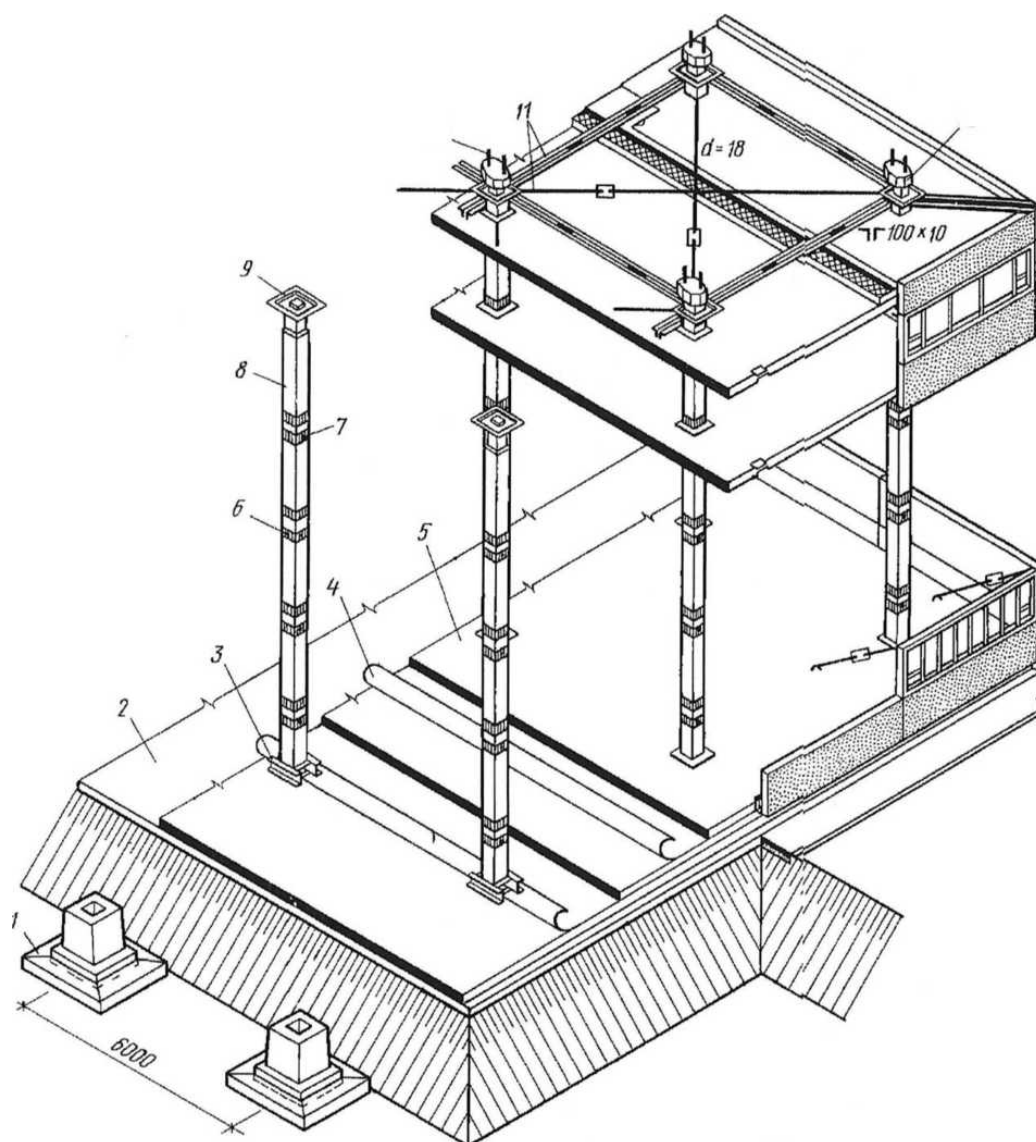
Багатоповерхова будівля, що зводиться методом підйому поверхів 1 - фундамент, 2 - підлога першого поверху, 3 - комірць, 4 -- роздільна прокладка, 5 - виготовлена плита, 6 - обойма колони, 7 - отвір 120x80 мм для закладного стрижня, 8 - колона, 9 - оголовок, 10 - гвинтова тяга діаметром 50мм, 11 - система монтажних зв'язків, 12 - габаритна схема гідропідйомника.
